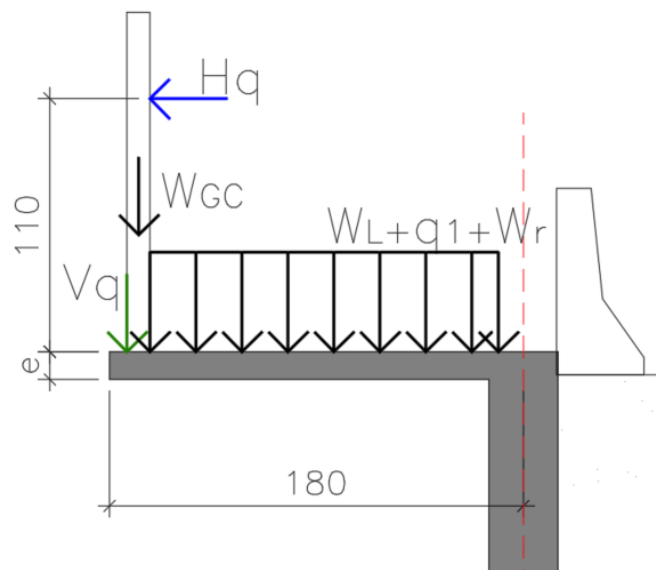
Diagrama de forças aplicadas na laje do Belvedere (Fonte: Autora).
